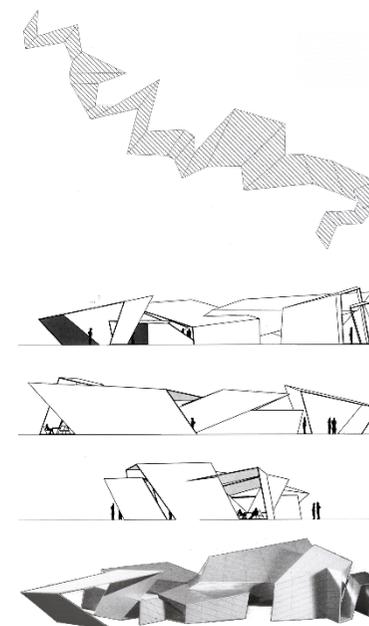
(1ª) Planta desplegada. (2ª) Diferentes Alzados. (3ª) Maqueta
